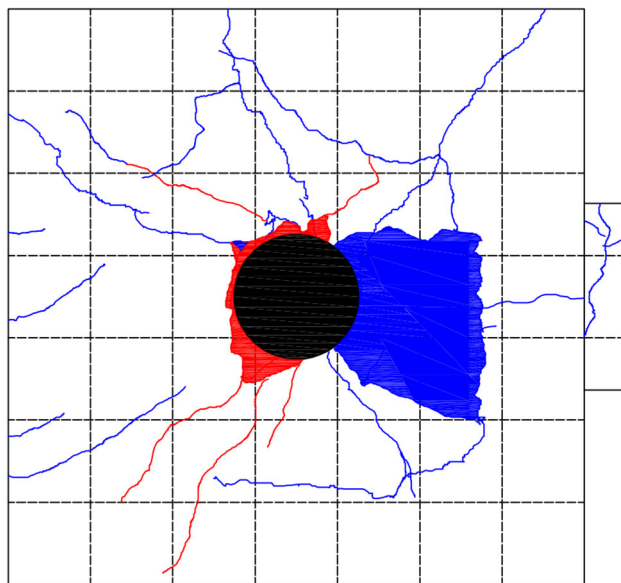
2. 4-7 試験体 DR-1 パイルキャップ底面最終損傷状況 (R=-3.0%)
